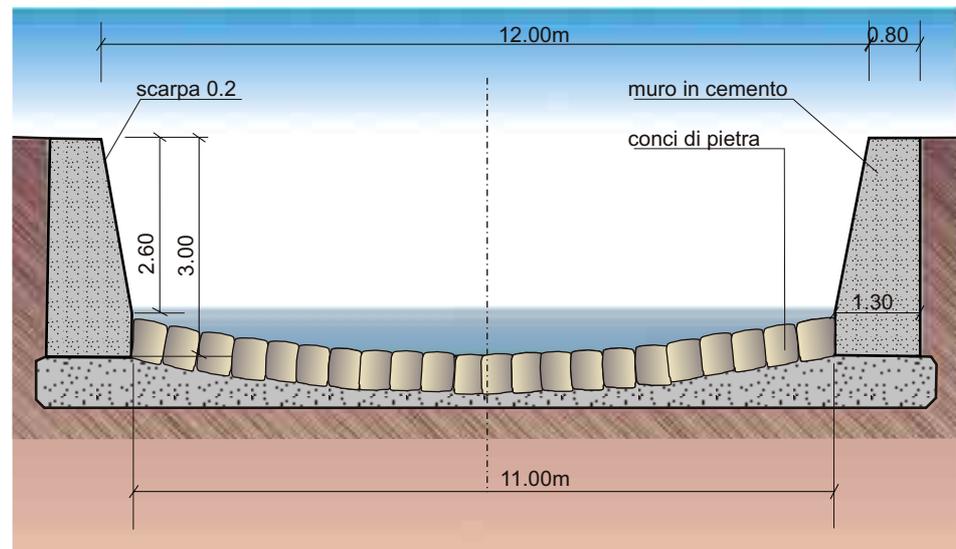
Nello schema a fianco è raffigurato un cunettone con muri di sponda e fondo in calcestruzzo rivestiti in pietrame. Il pietrame oltre a migliorare l'impatto visivo dell'opera ha la funzione di proteggere il calcestruzzo dall'abrasione e dagli urti dovuti al materiale, anche di grosse dimensioni, in carico alla corrente.
